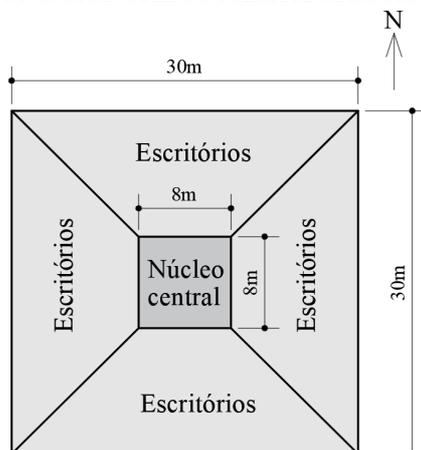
Croqui da planta baixa do pavimento tipo do edifício.
